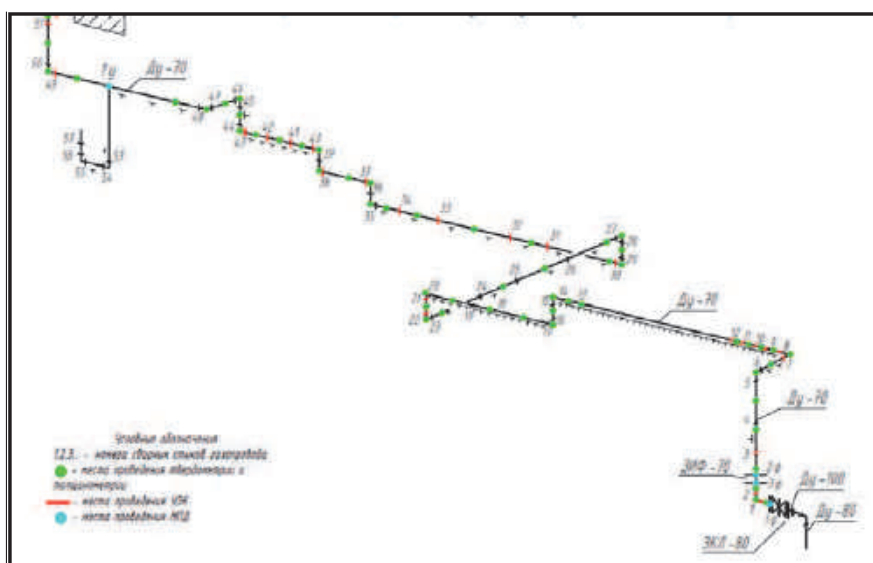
Схема наружного надземного газопровода среднего давления
